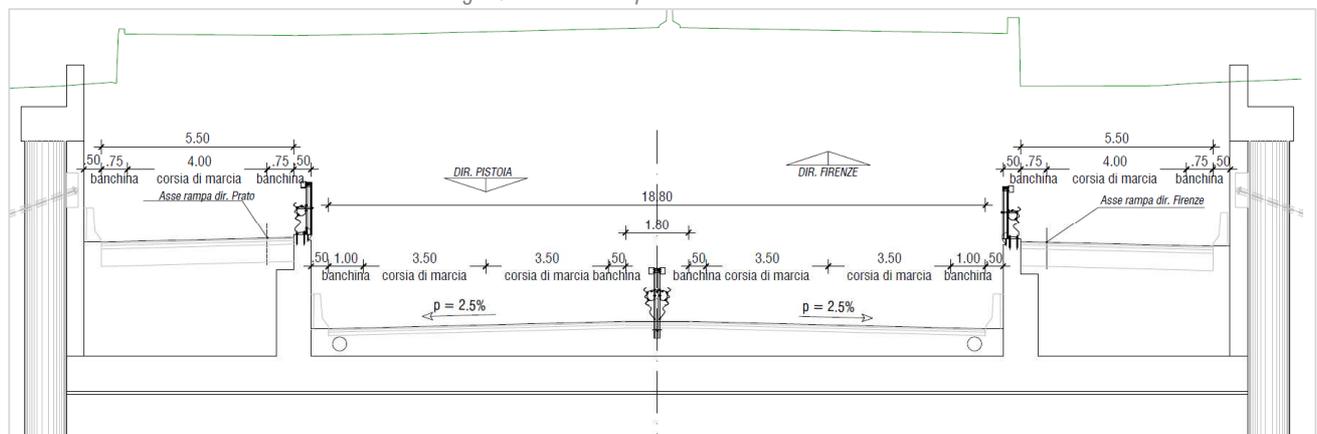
Sezione tipo "ASSE PRINCIPALE CON RAMPE IN AFFIANCAMENTO"
